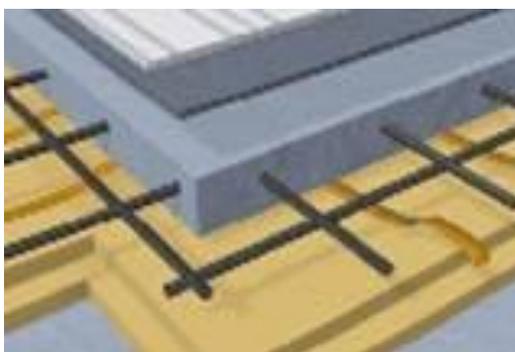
Esquema de instalación de aislamiento con XPS en forjado. Fuente IDAE 2010
